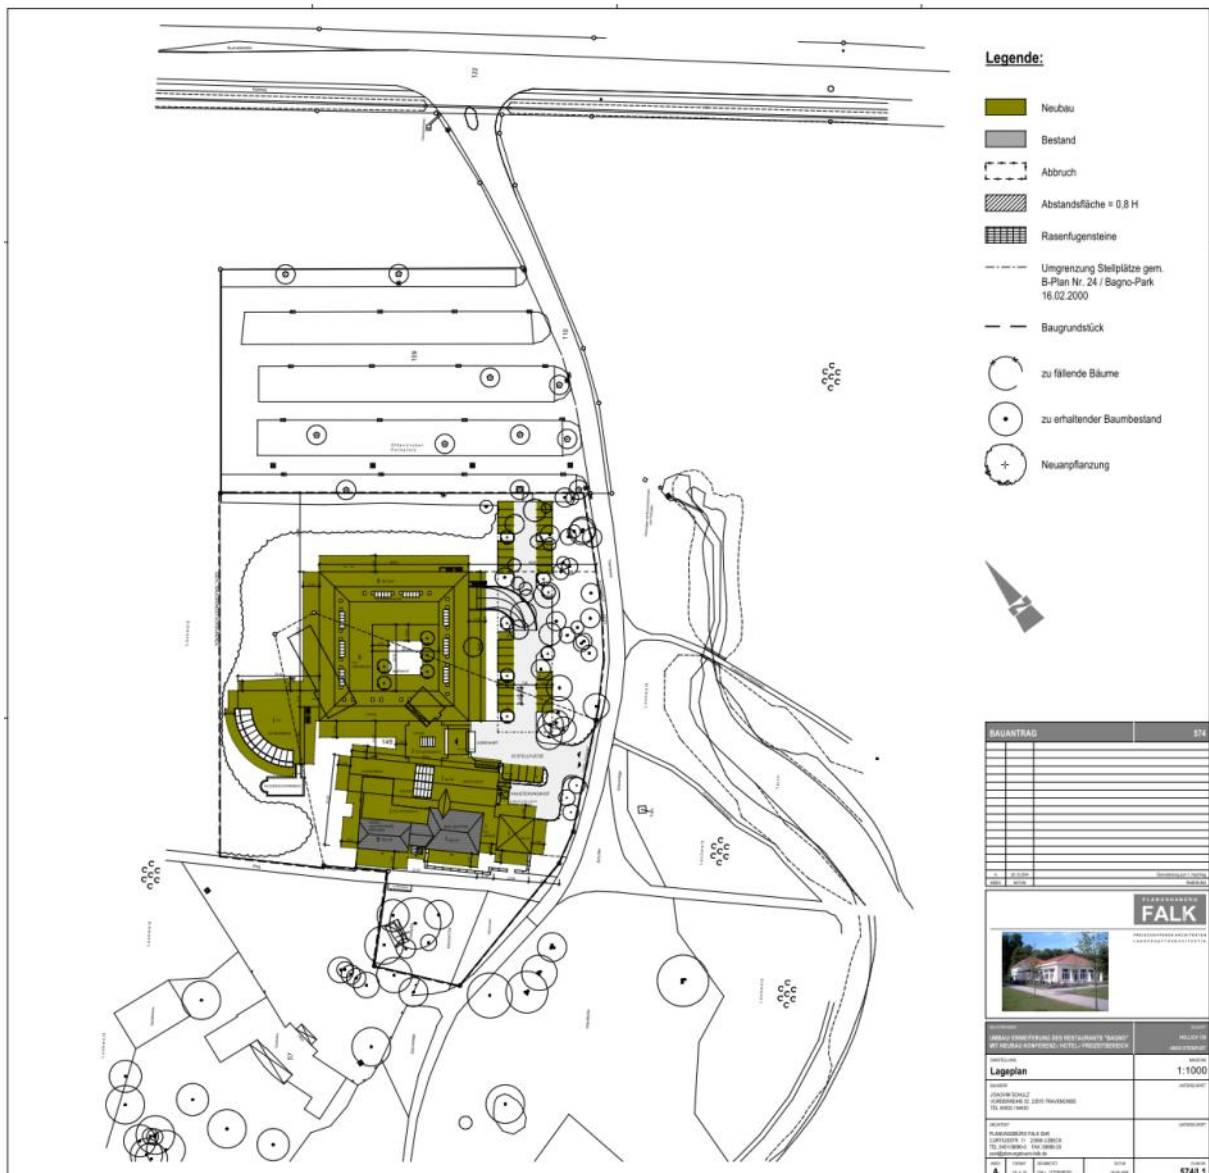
Planung Hotelneubau (Quelle: PLANUNGSBÜRO FALK GBR 1999).
